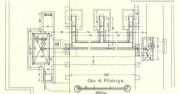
Hydraulický osvětlení na rovné propusti.
